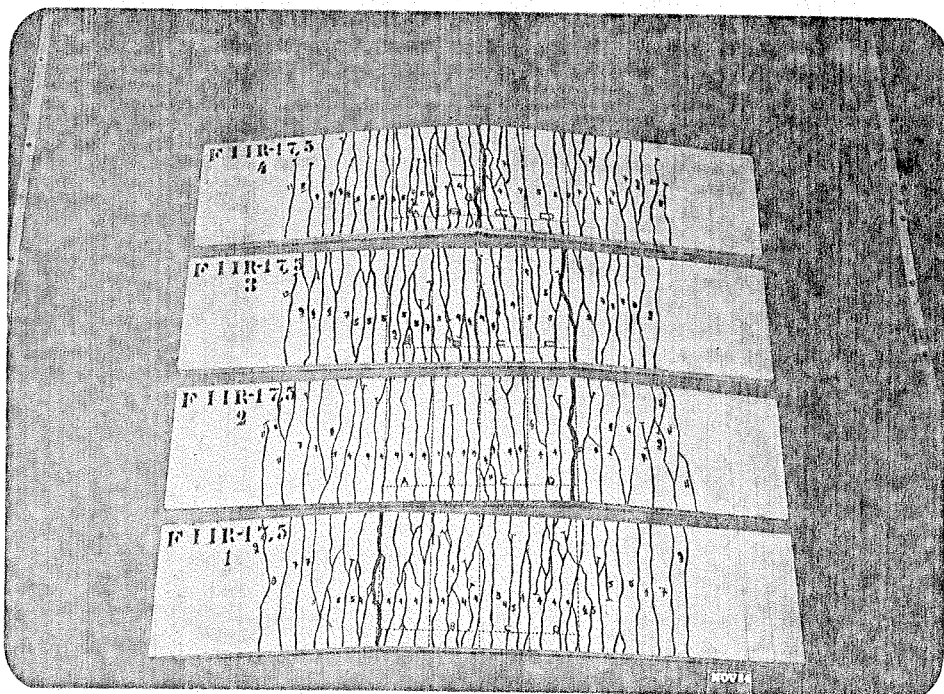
Fissuração final - SERIE F11R17.5
